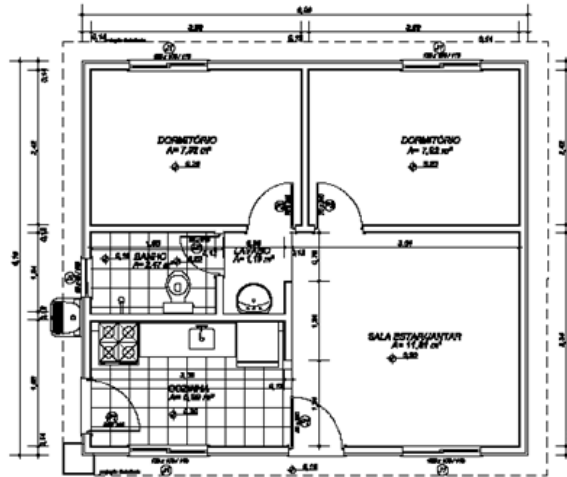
Planta Casa popular Quick House - 43m².
